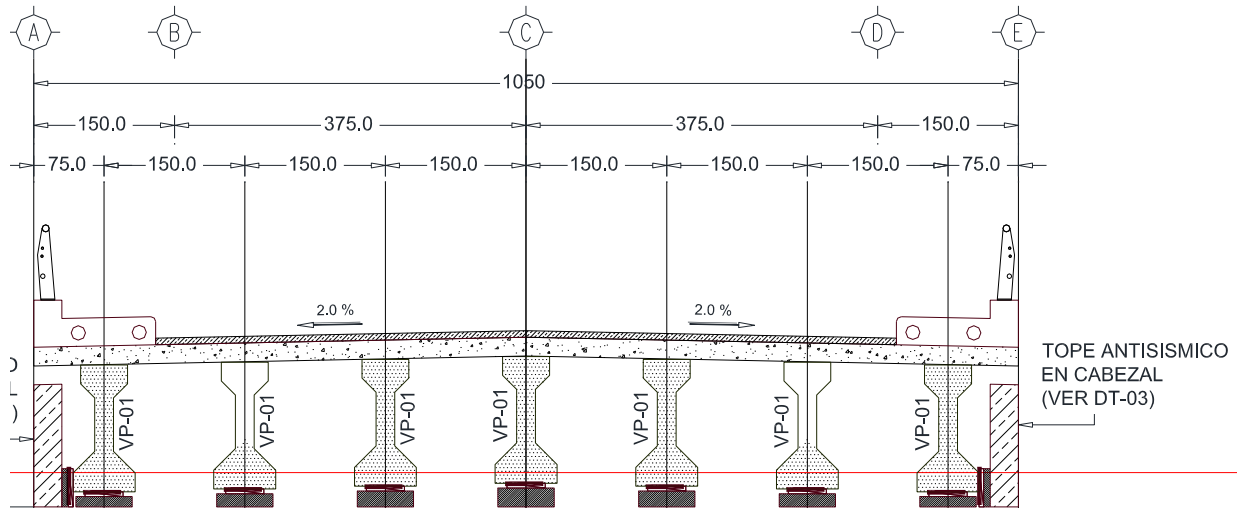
Sobre las coronas o cabezales de los estribos de las pilas se construirá una estructura de refuerzo a base de concreto armado amortiguada por placas de neopreno y topes sísmicos que soportarán las vigas.
